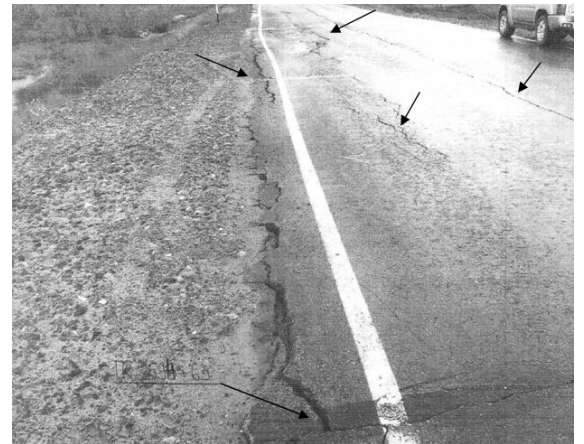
Разрушенный участок дороги (ПК 594+30). Разрушение кромки покрытия
